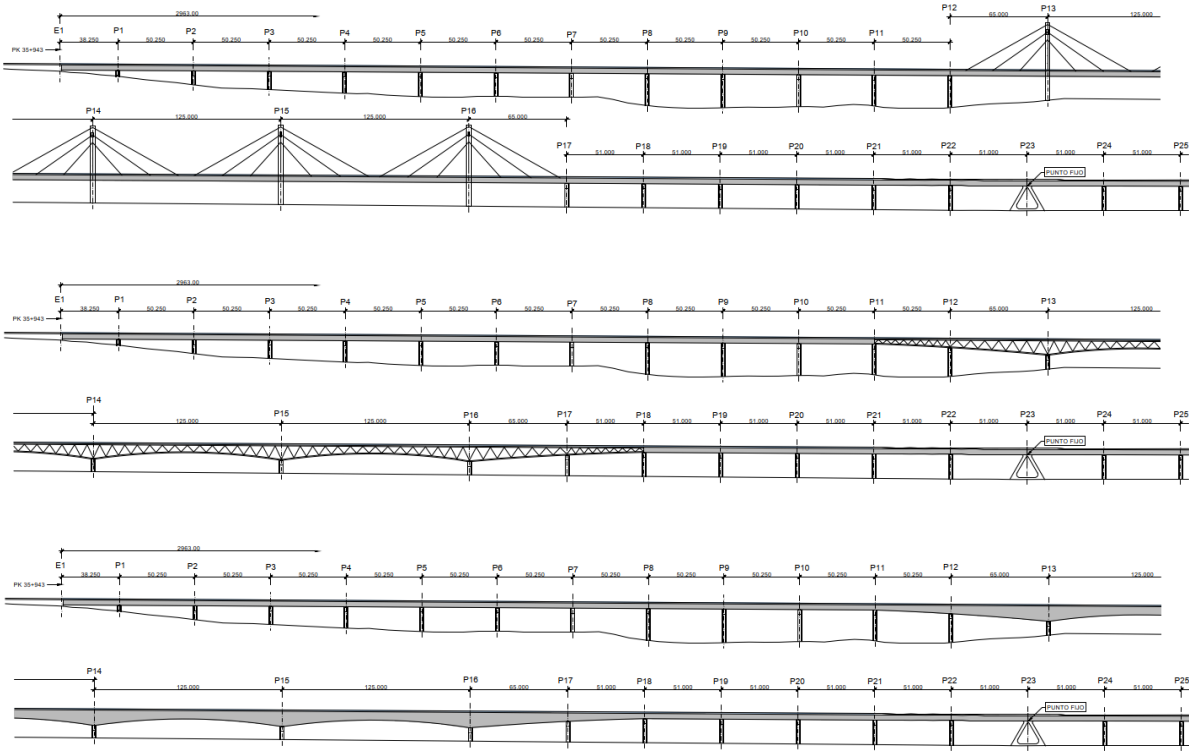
Alternativas viaducto sobre la ría de Treto (Alzados)
